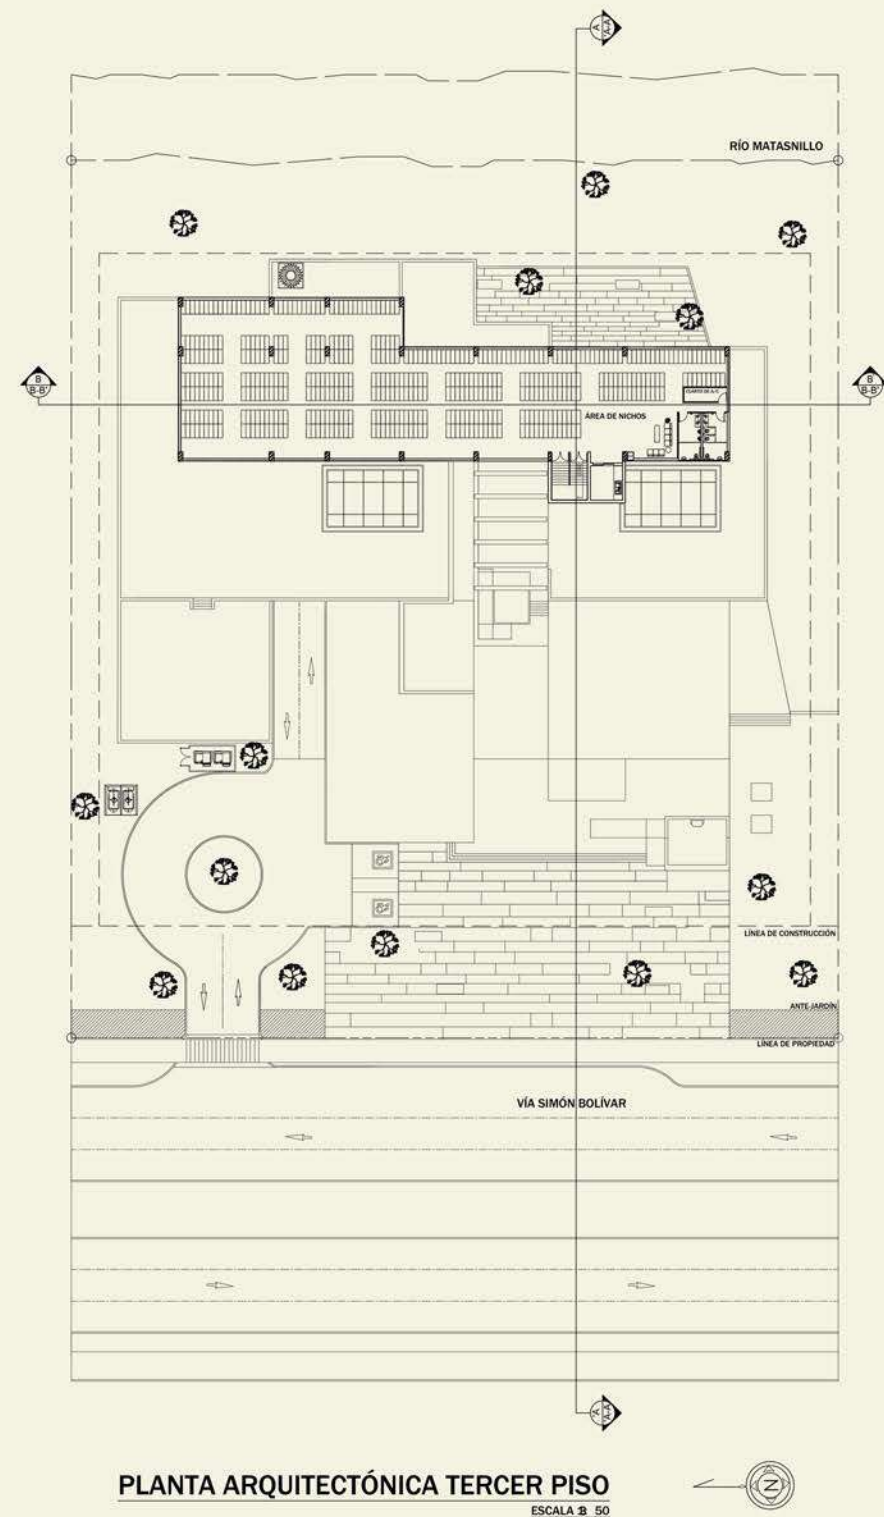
Planta arquitectónica tercer piso. (Escala para plano 2x3)
